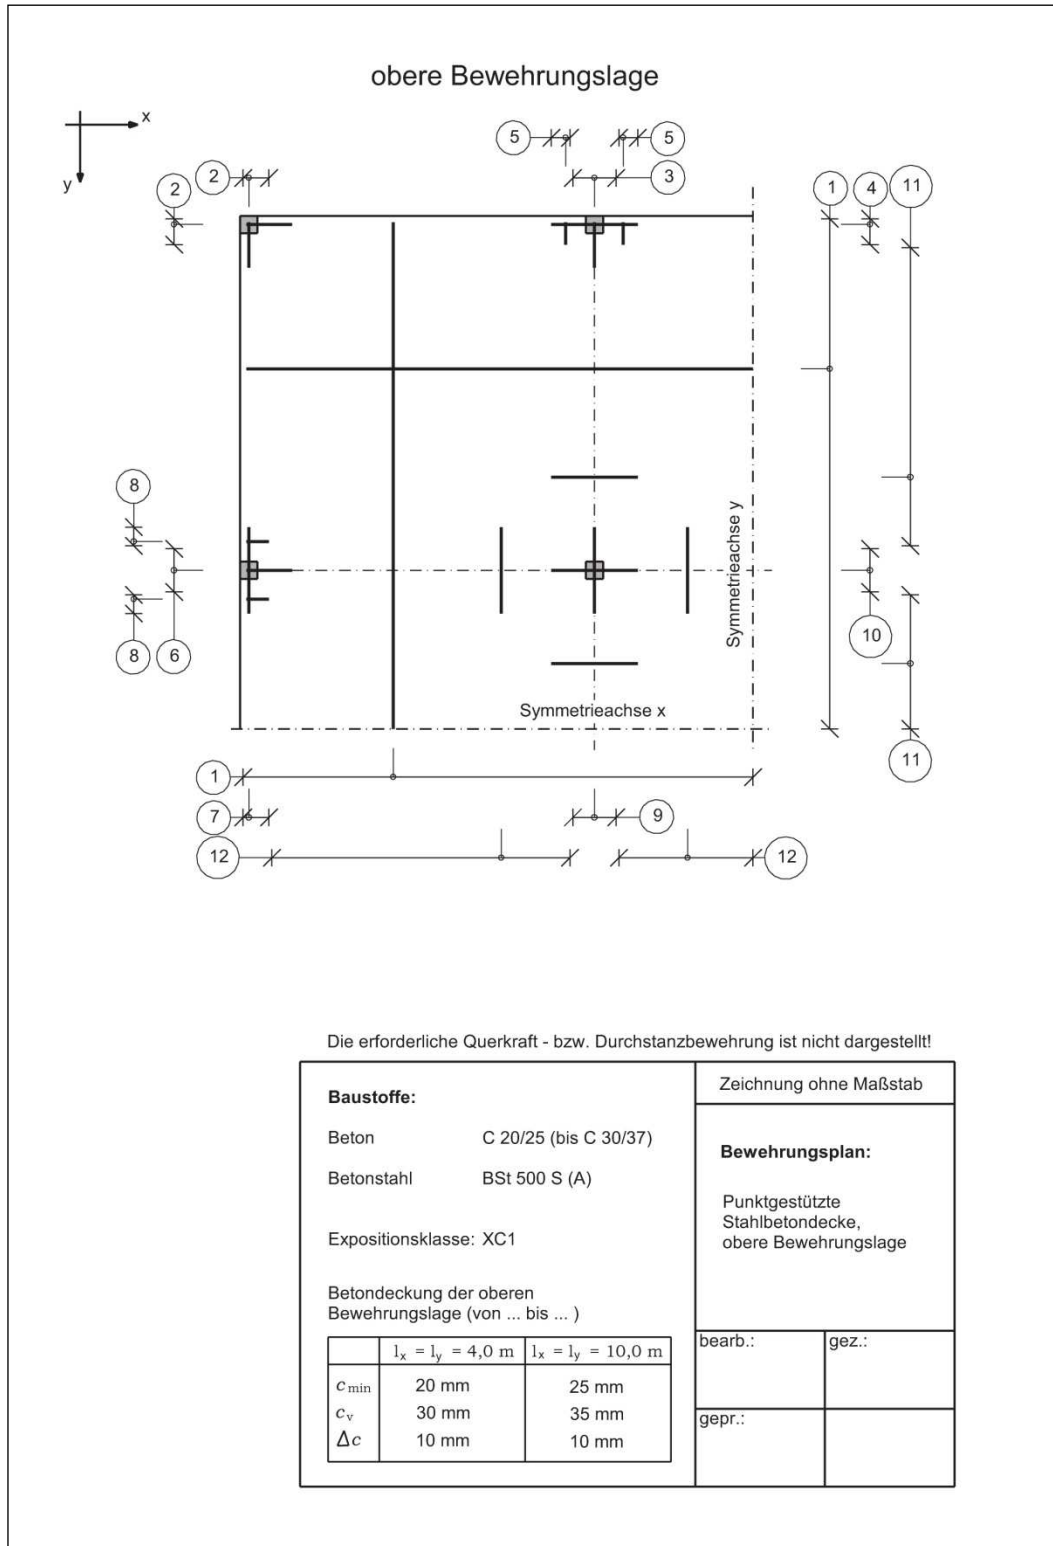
Bewehrungsplan der oberen Bewehrungslage für die untersuchten punktgestützten Stahlbetonplatten (schematisch)
